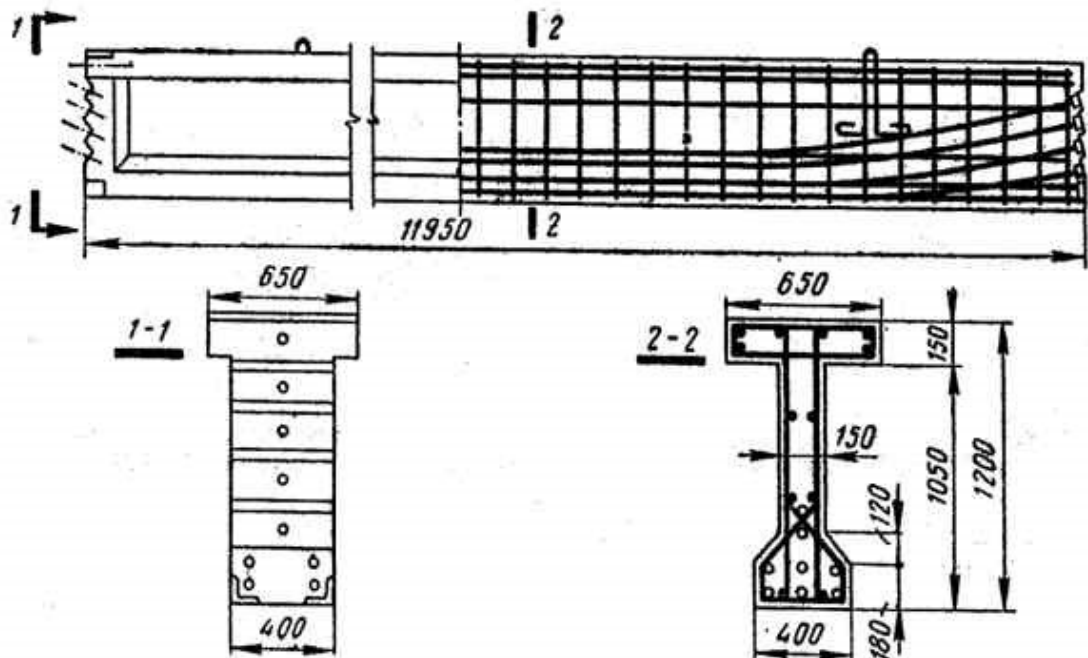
Конструкция предварительно напряженной подкрановой балки
